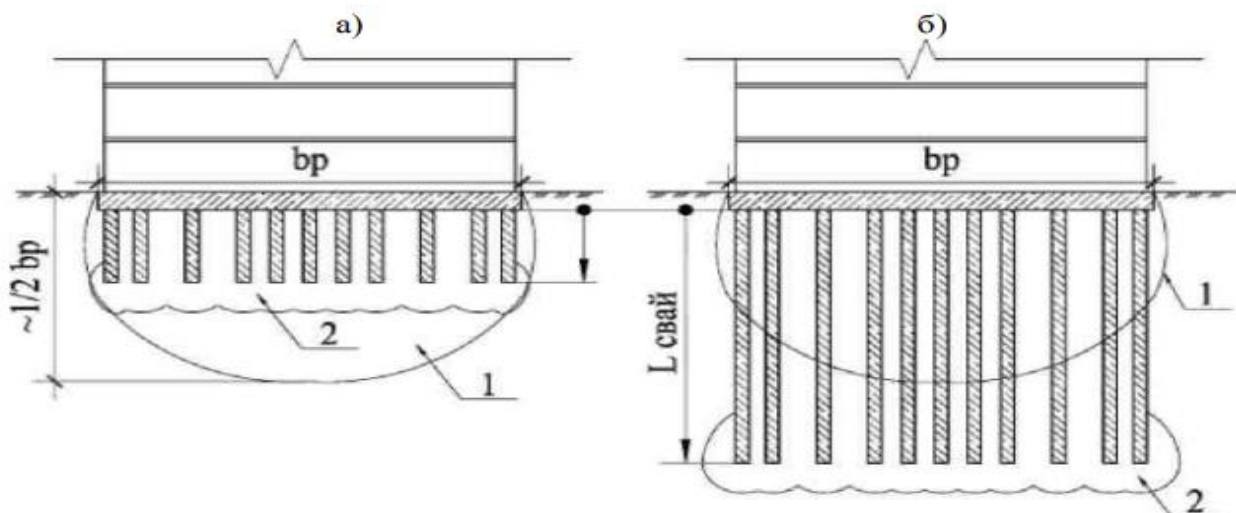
Взаємодія фундаментних конструкцій з ґрунтовим масивом:
